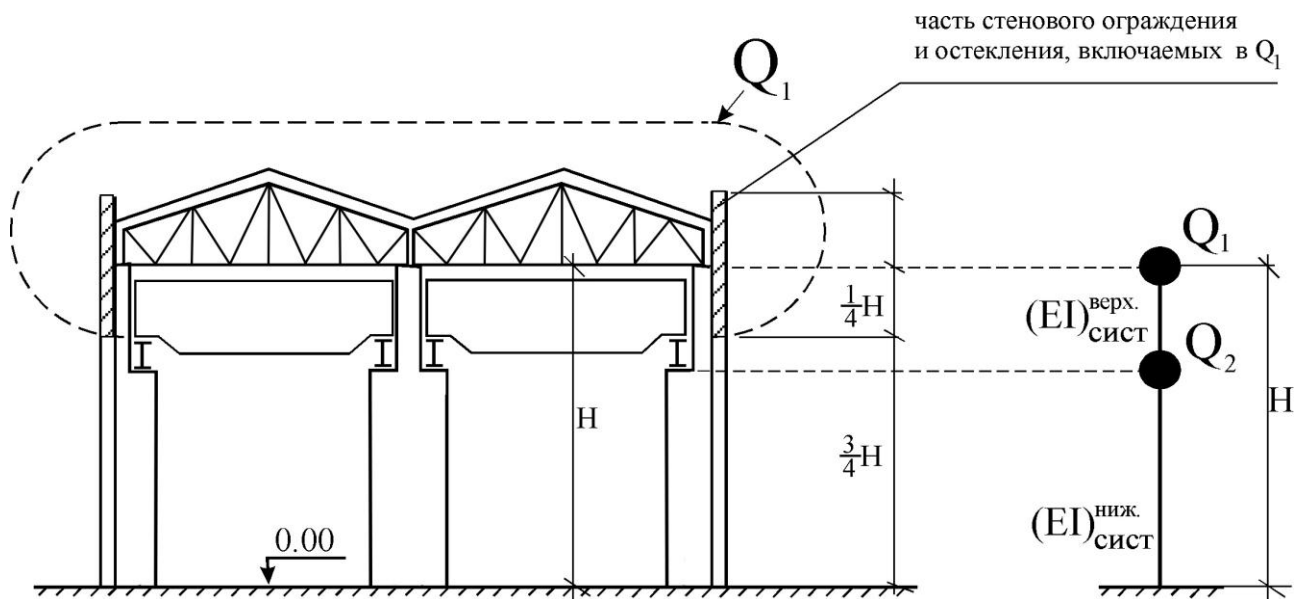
Формирование динамической расчетной схемы для производственного здания с мостовыми кранами (вариант с шарнирным соединением балок с колоннами)
